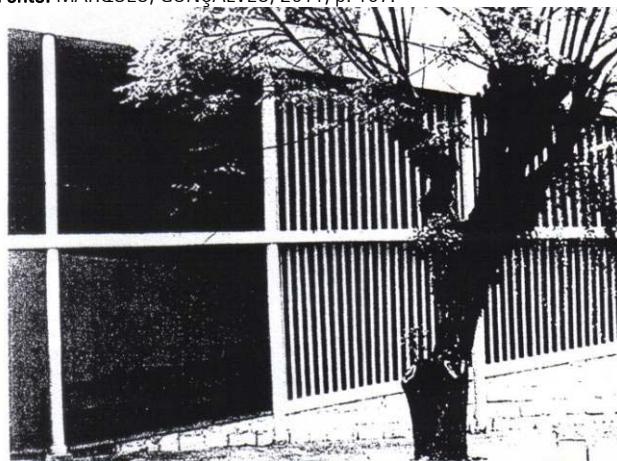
Brises de concreto aplicados à fachada do Sanatório Partenon, Rio Grande do Sul.
